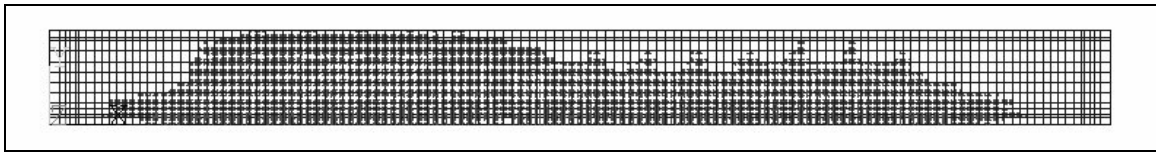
Dalle 1A Schéma de fissuration
